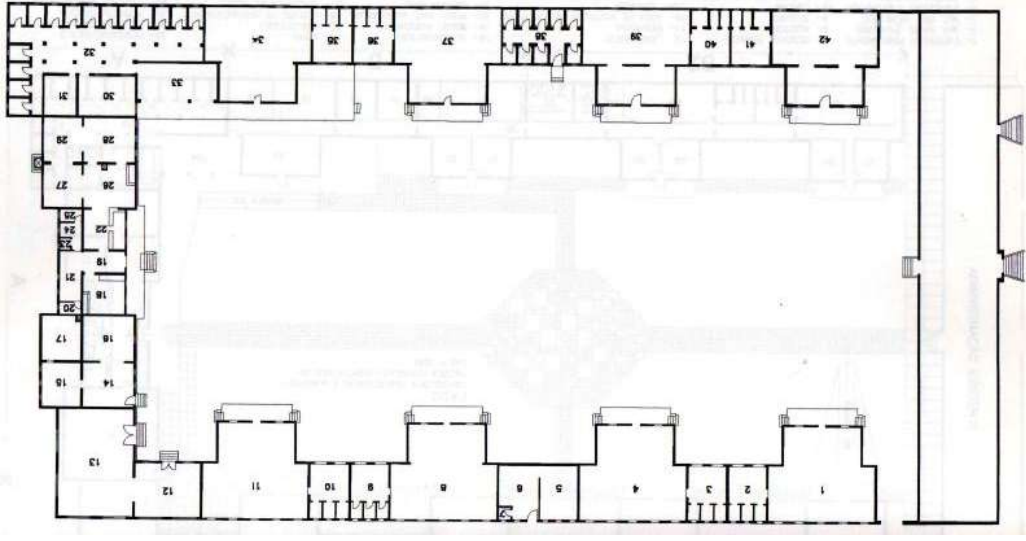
Planta do Presídio da Ilha Anchieta, 1998.
